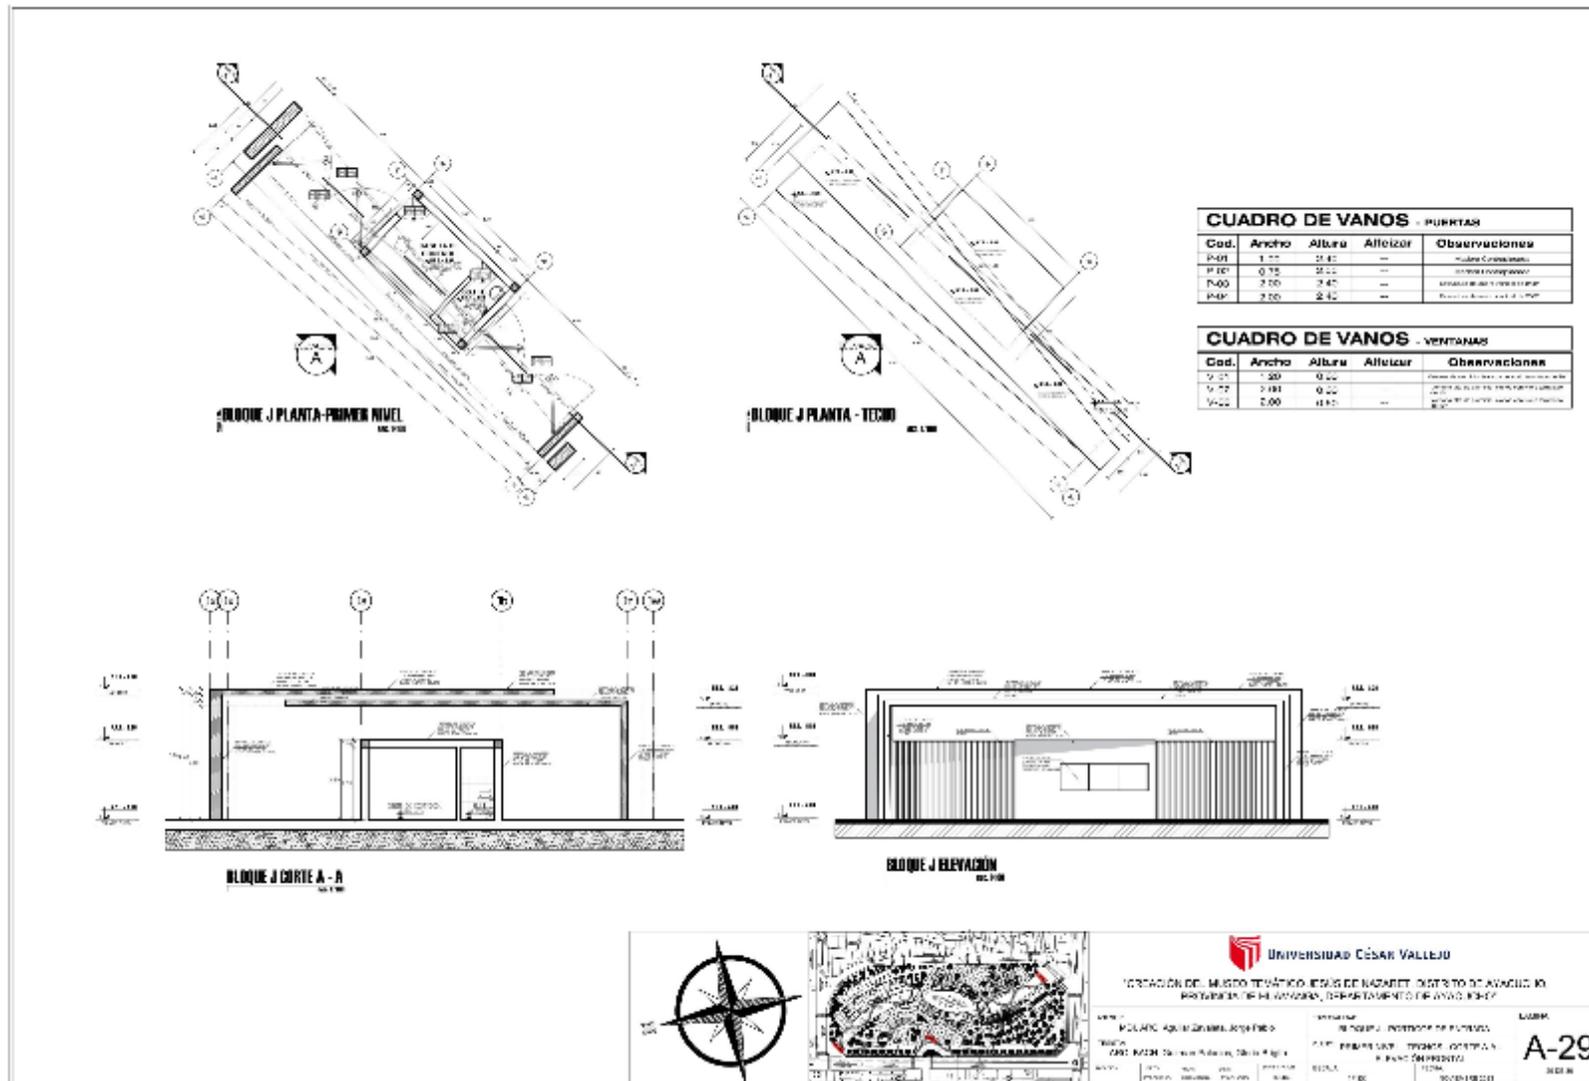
Bloque J – Plantas, cortes y elevaciones.
